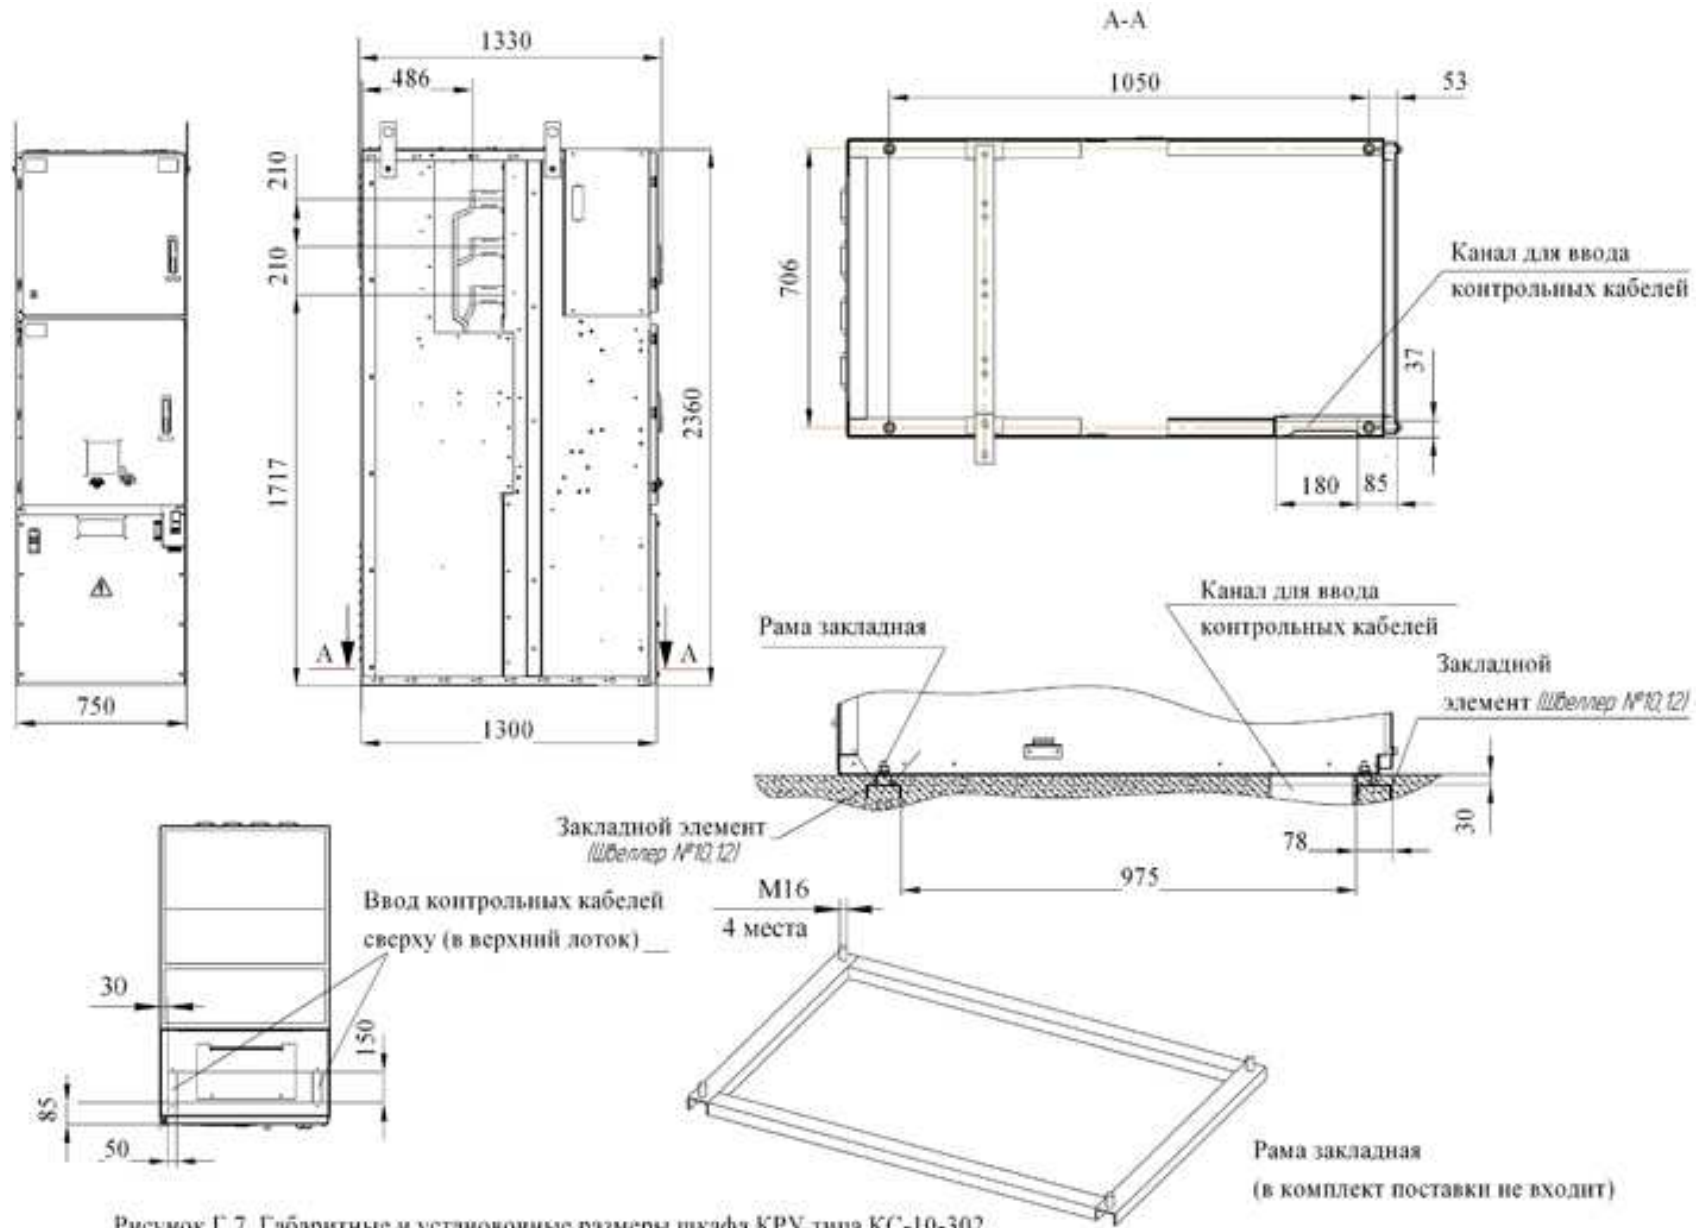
Габаритные и установочные размеры шкафа КРУ типа KC-10-302
